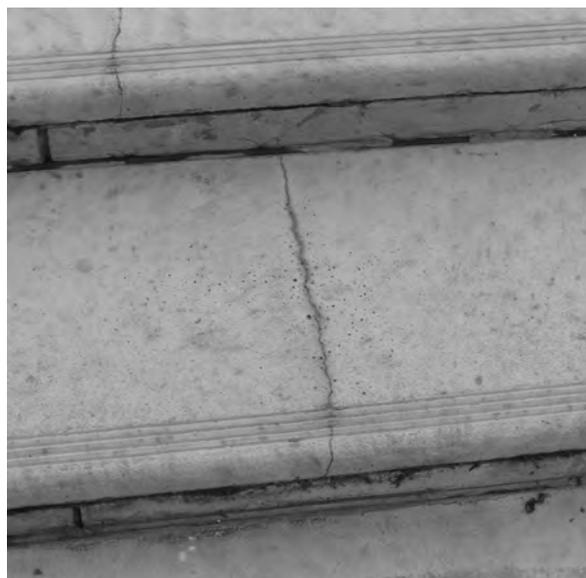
Повреждения накладных проступей железобетонных лестниц стадиона «Динамо»
